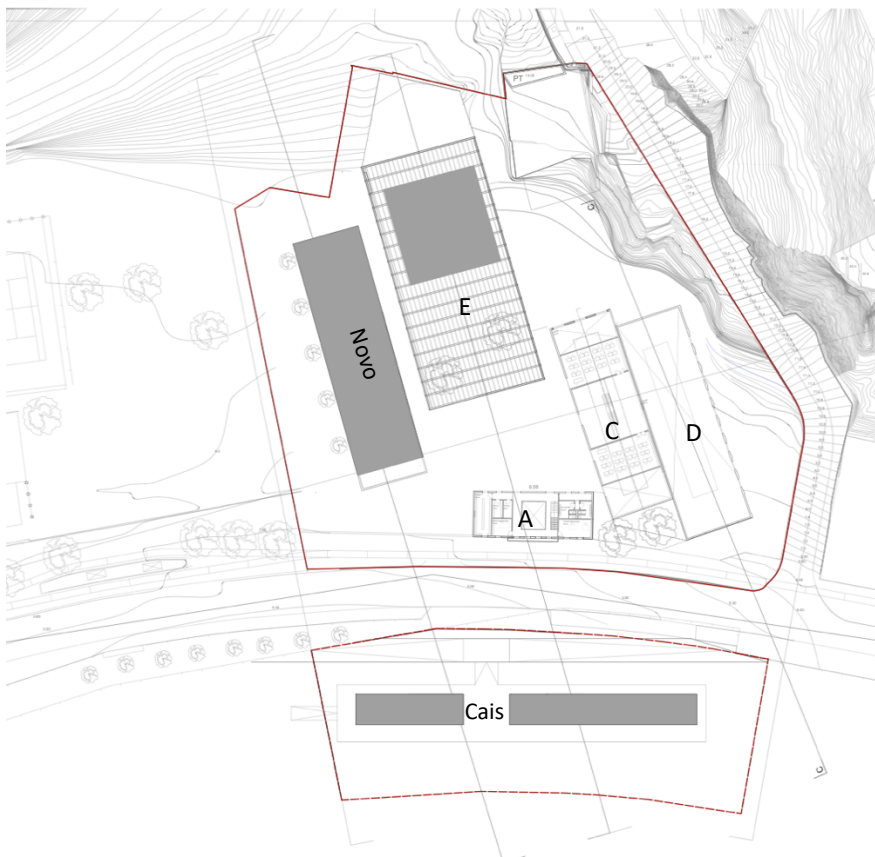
Planta piso 1 – 5ª proposta (fonte: autora)
